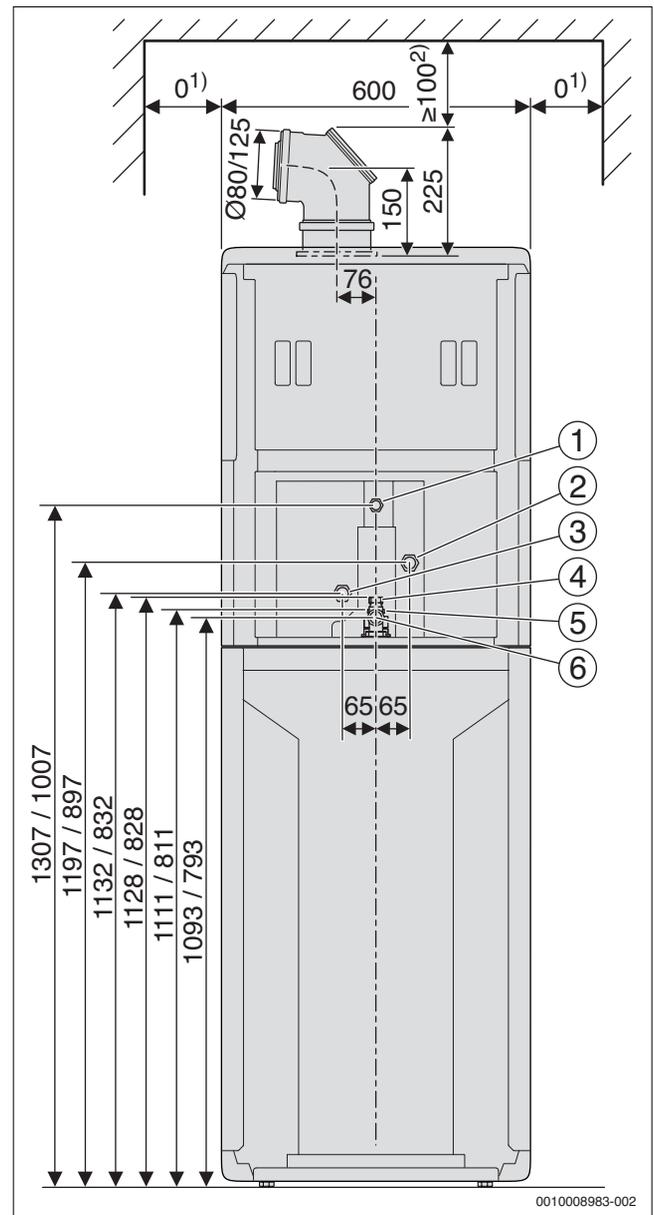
Abmessungen und Anschlüsse ohne Zubehöre, Rückansicht, (Maße in mm)
